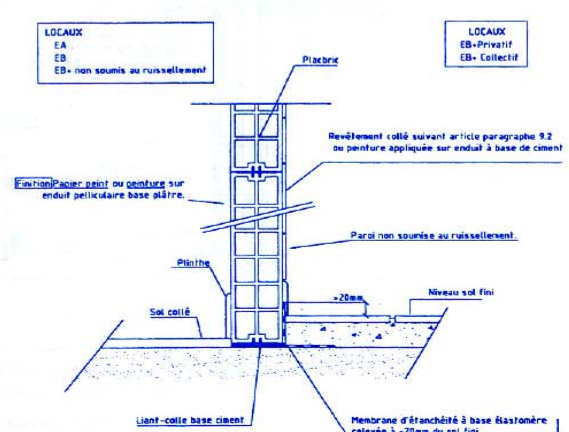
c - Pied PLACBRIC séparant locaux EB + privatif / EB + collectif (carrelage) de locaux EA, EB (enduit peinture)
